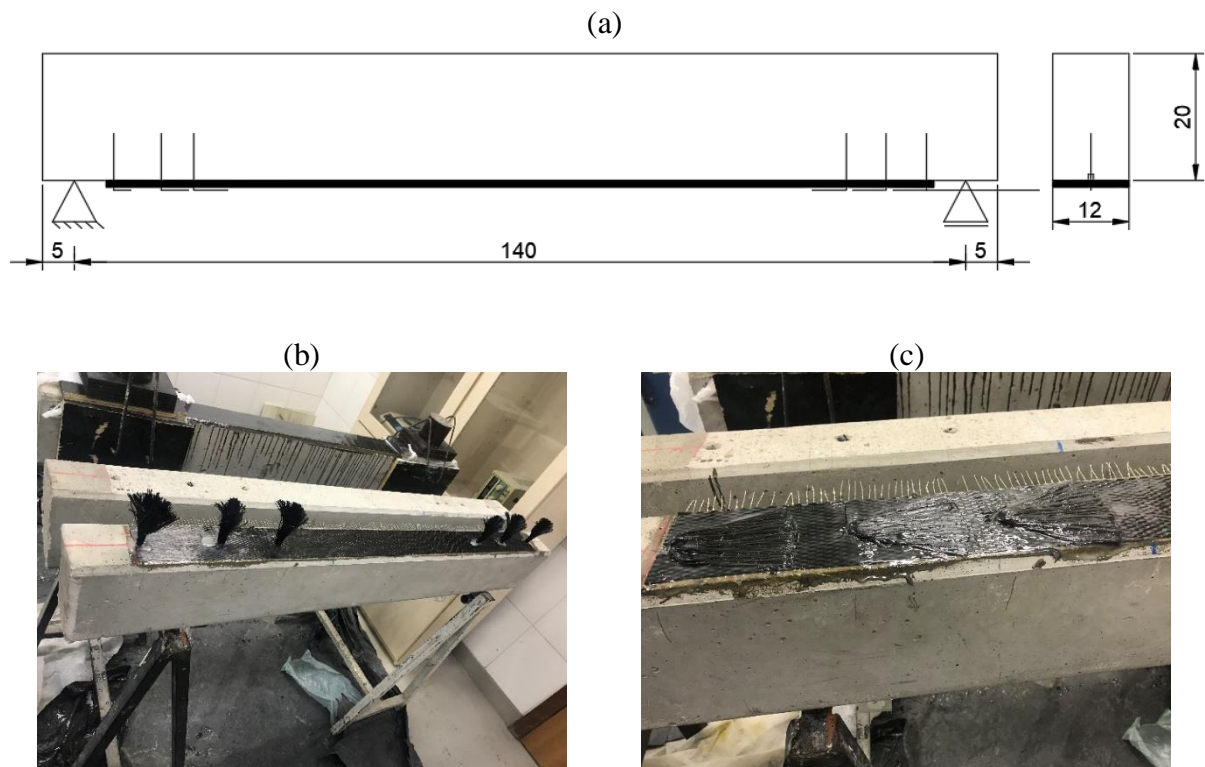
Vigas com aplicação de ancoragem nas extremidades do tipo laço U e ranhura EBRIG (vigas VDA)
